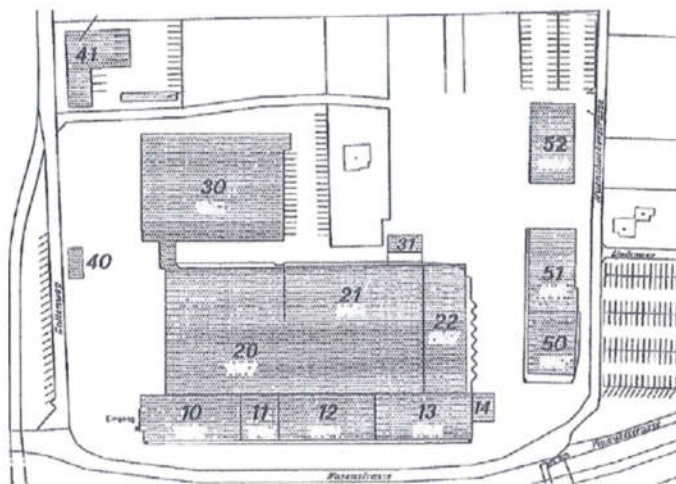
Übersichtsplan der bestehenden Bauten mit Nummerierung
